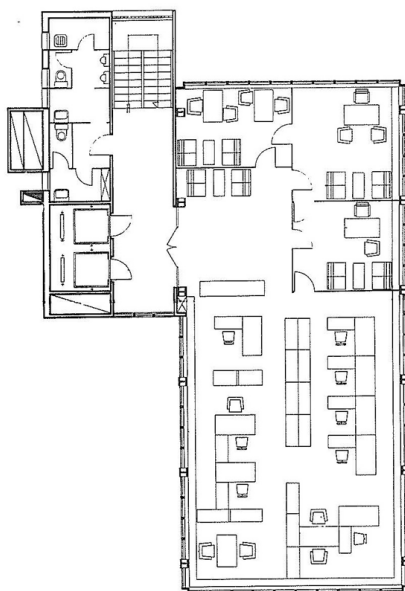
Planta quinta del Colegio de Arquitectos.
